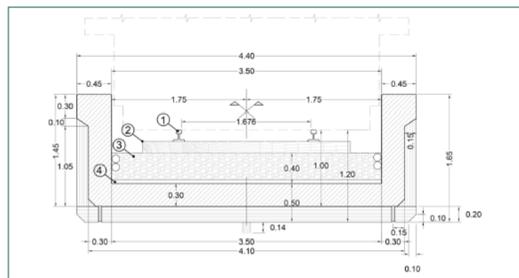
Sección transversal típica de sección U con cabeza comprimida ensanchada
